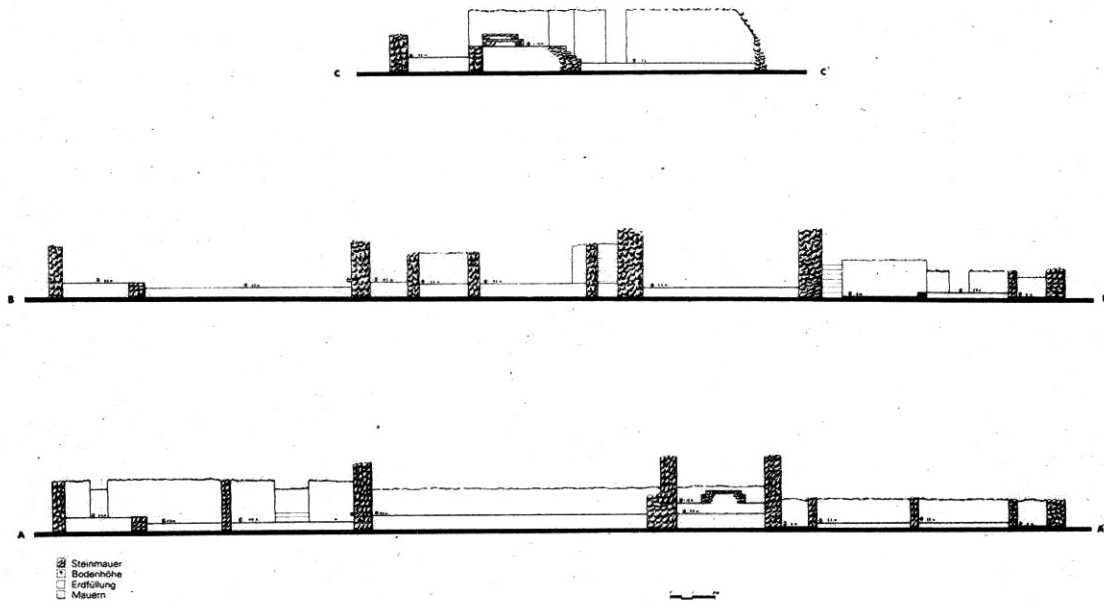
Corte transversal del Edificio 49. Levantó: Alejandro Arenas Villalón
